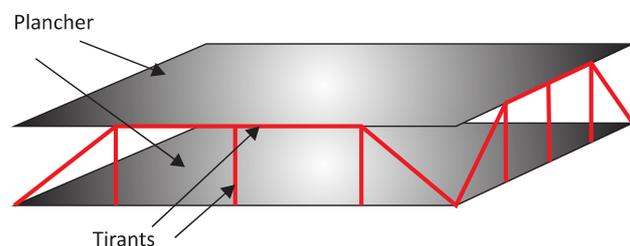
Exemple d'un renfort d'une ouverture
